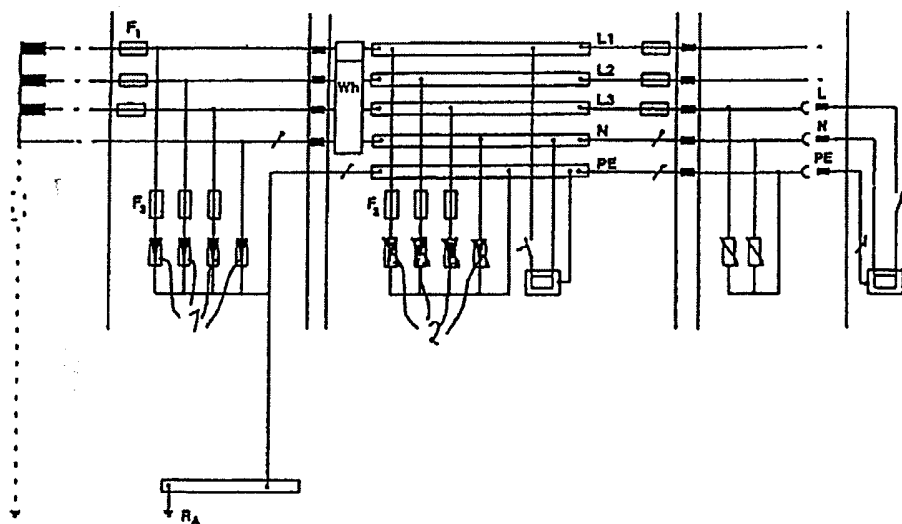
Zapojení přístrojů k ochraně před přepětím v rozvodné soustavě typu TN
